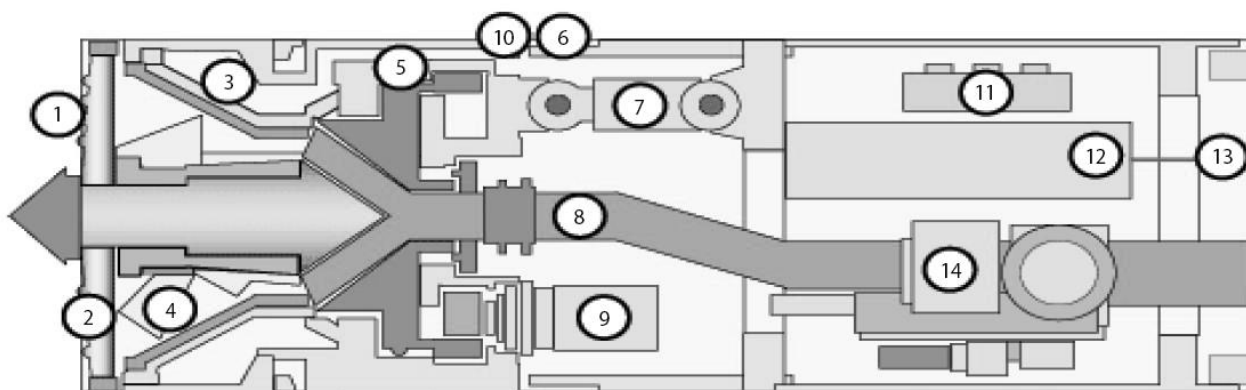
Конструкция проходческой машины с гидротранспортировкой грунта: 1- впайки из твердых металлов; 2- рабочий орган ; 3- отверстие для подачи воды; 4- дробильное пространство; 5- главный подшипник; 6- прокладка; 7- домкрат управления; 8- транспортирующий трубопровод; 9- силовой привод; 10- питающий трубопровод; 11- вентили; 12- лазерная мишень; 13- лазерный луч; 14- байпас
